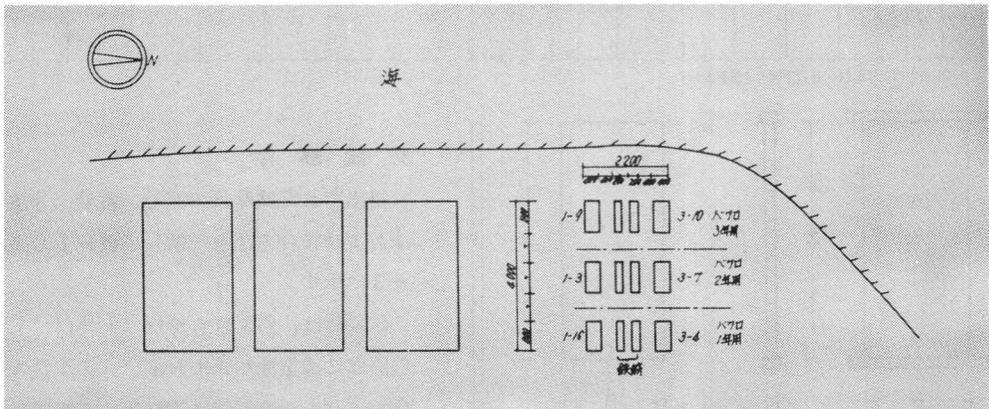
試験体配置図 (三井金属鉱業(株)中央研究所, 三鷹市)
